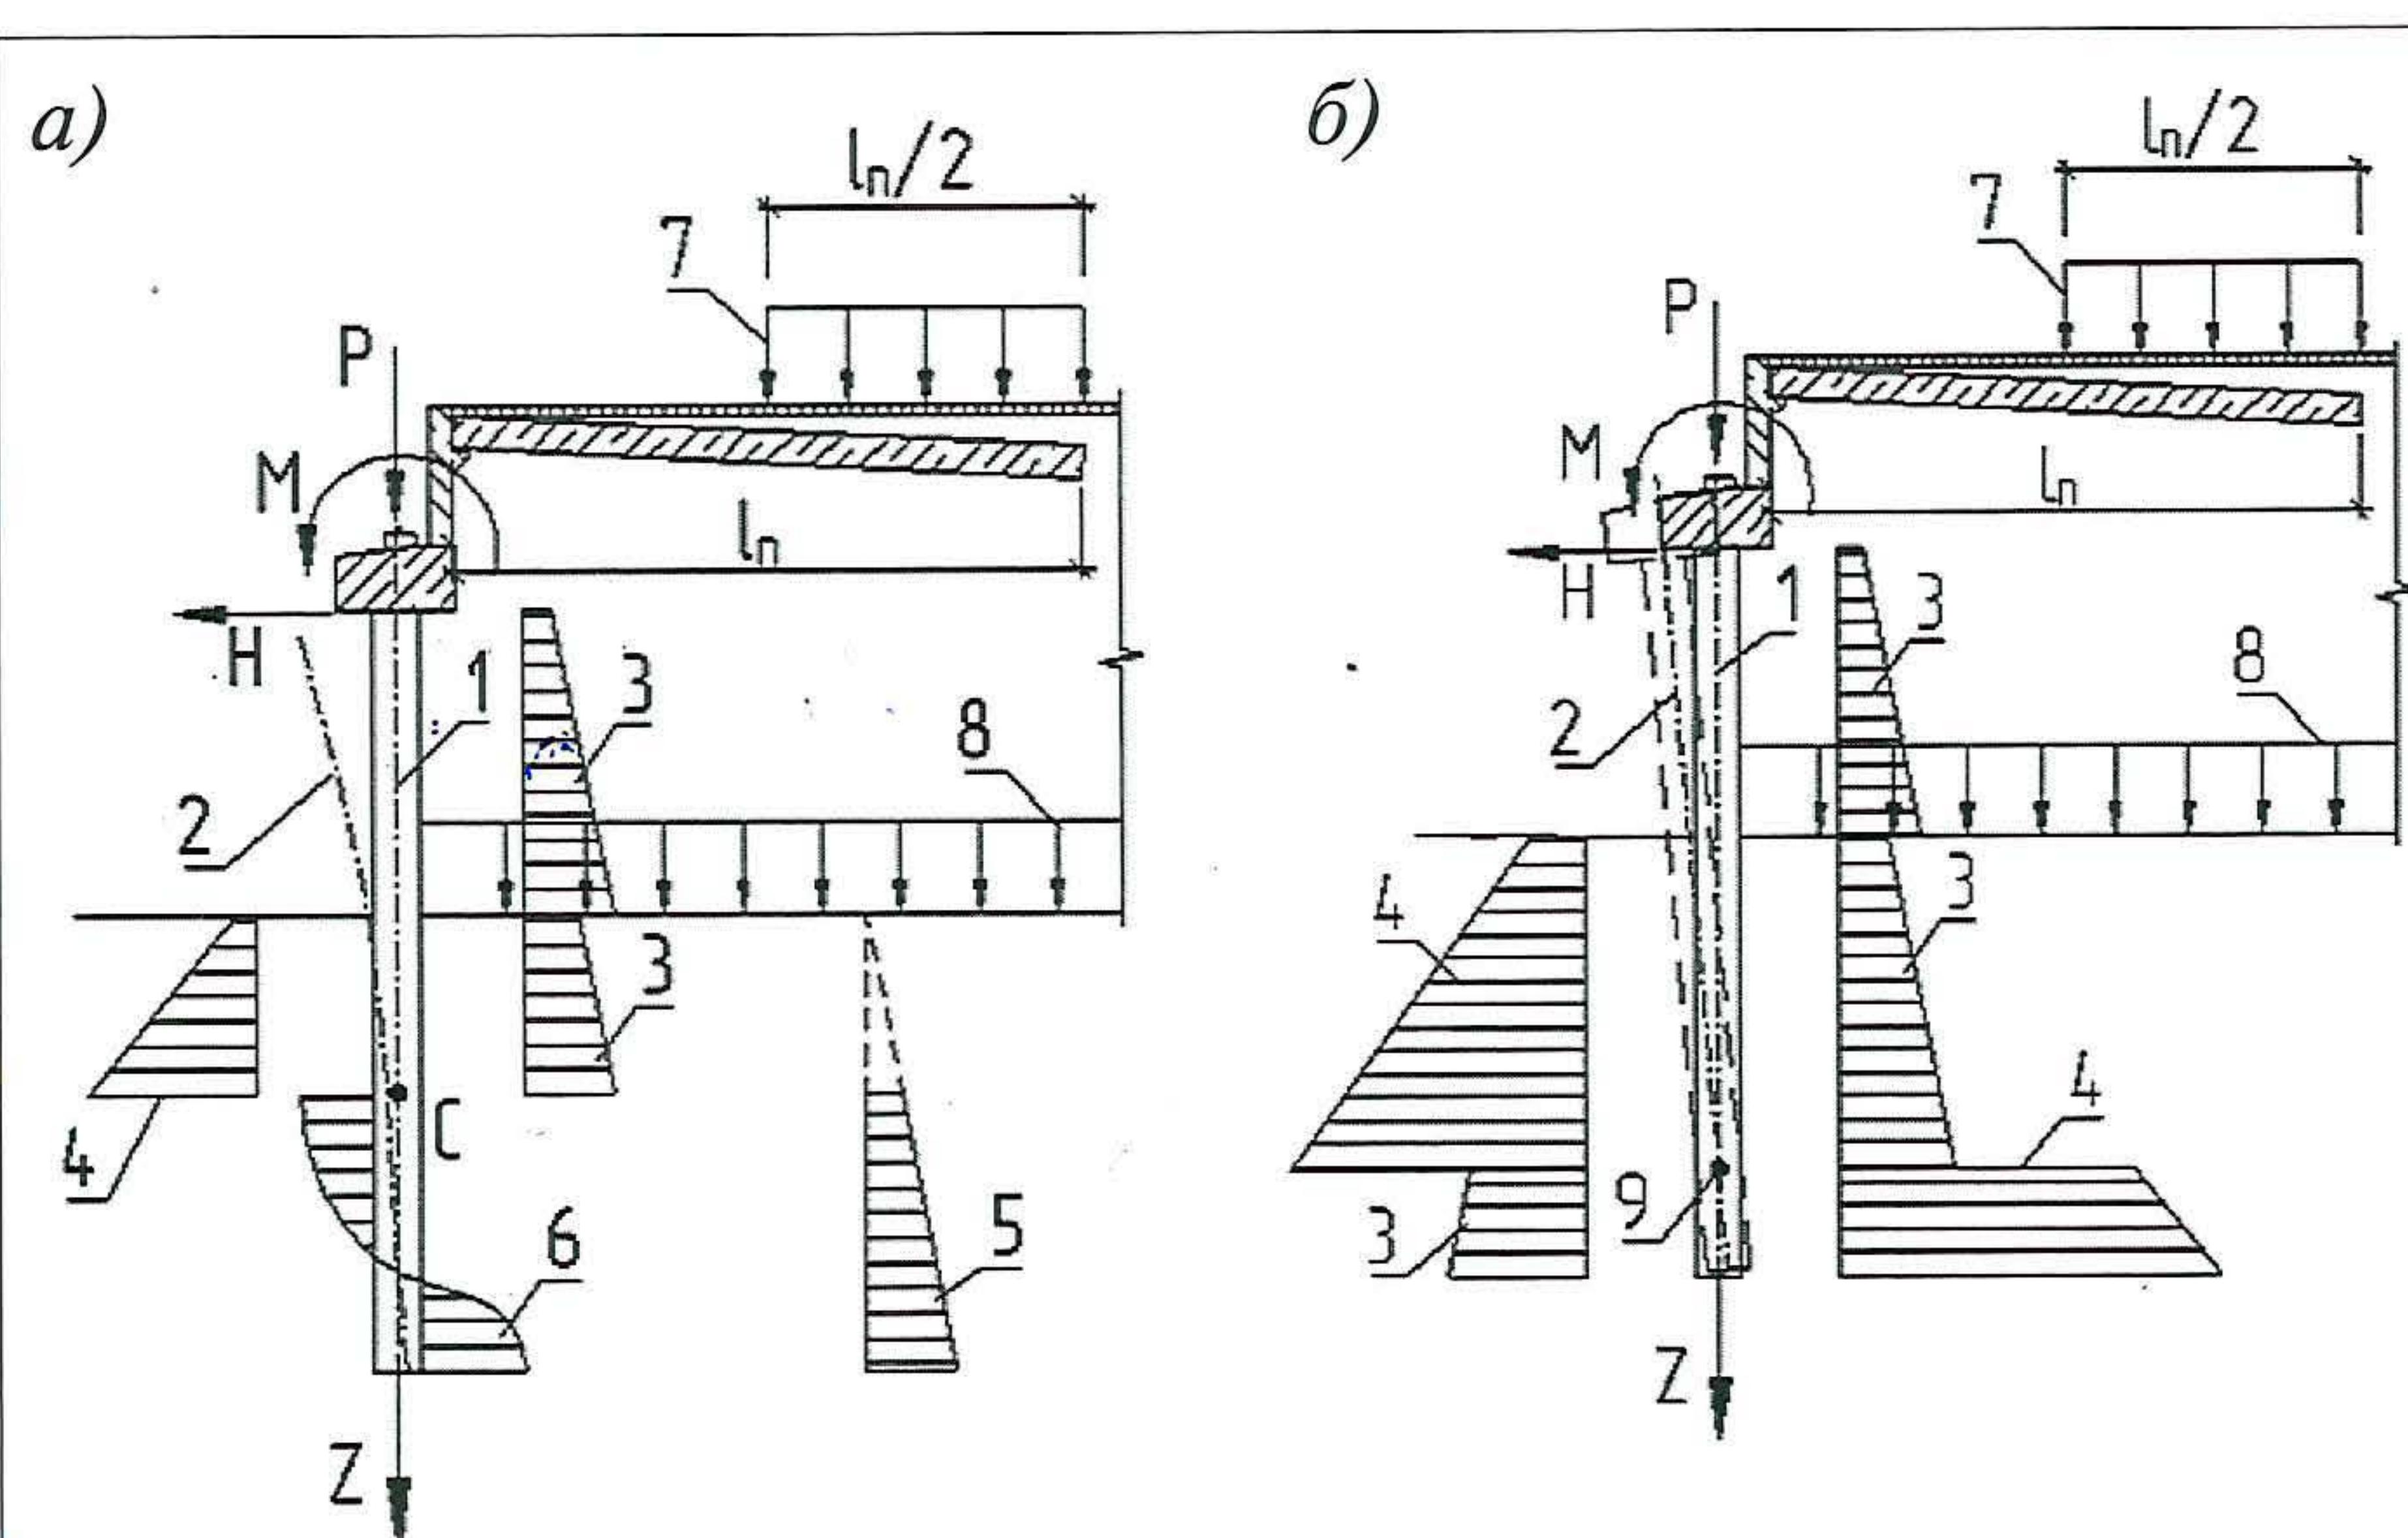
Расчетные схемы инженерного метода расчета мостовых устоев: а – комбинированная расчетная схема, б – расчетная схема предельного равновесия моментов при повороте шпунтового ряда; 1, 2 – первоначальная и деформированная оси устоя, 3 – эпюры активного давления грунта, 4 – эпюры пассивного давления грунта, 5, 6 – эпюра распределения коэффициента постели и контактных давлений в заделке шпунтовой стенки, 7 – нагрузка, передаваемая на насыпь переходной плитой, 8 – давление на основание, 9 – ось поворота шпунтового ряда
